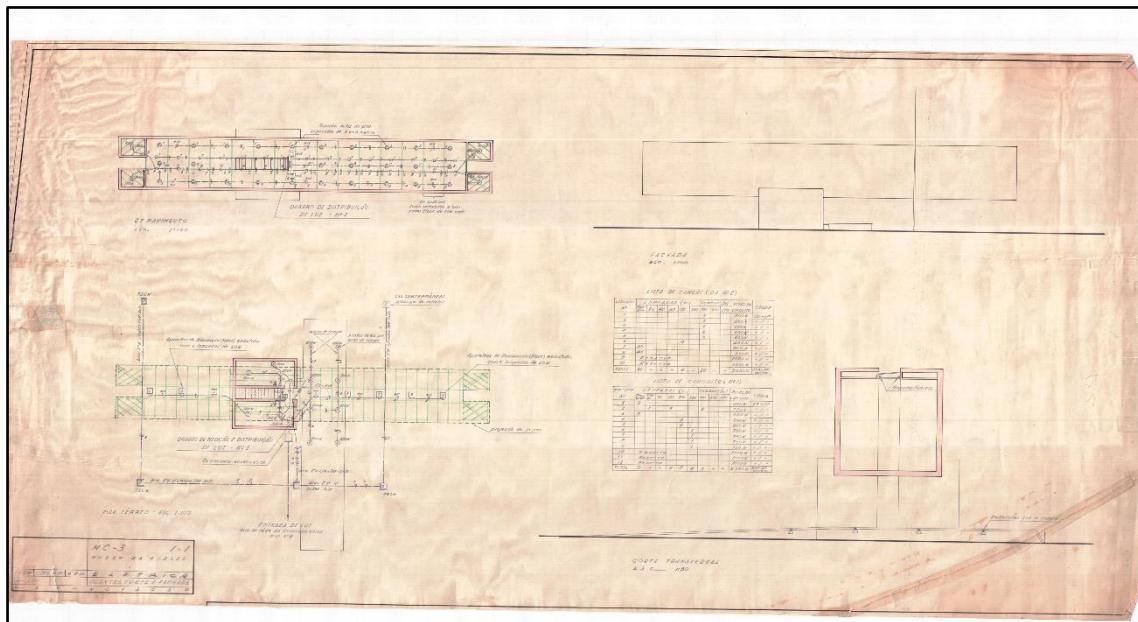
Jun. 1958 – Museu da Cidade. M.C.-3 1-1 Escalas 1:50 e 1:100. Elétrica – Planta, Cortes e Fachada. D.A.U.-NOVACAP. Arquivo: MC - IEL - 000-0 - 001-01 - 0001554 - 1958-06 - Instalação elétrica - Plantas, corte e fachada. Fonte: SUPAC/SECULT-DF.
